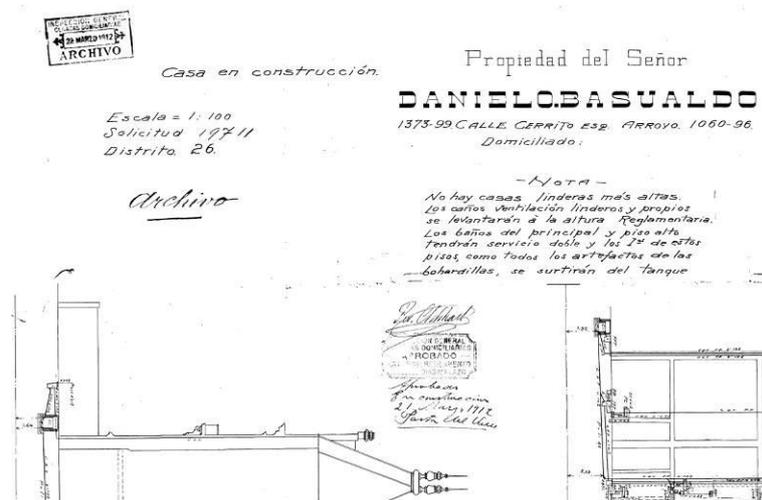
Plano del Palacio año 1912 (detalle). Fuente: Archivo AySA.
